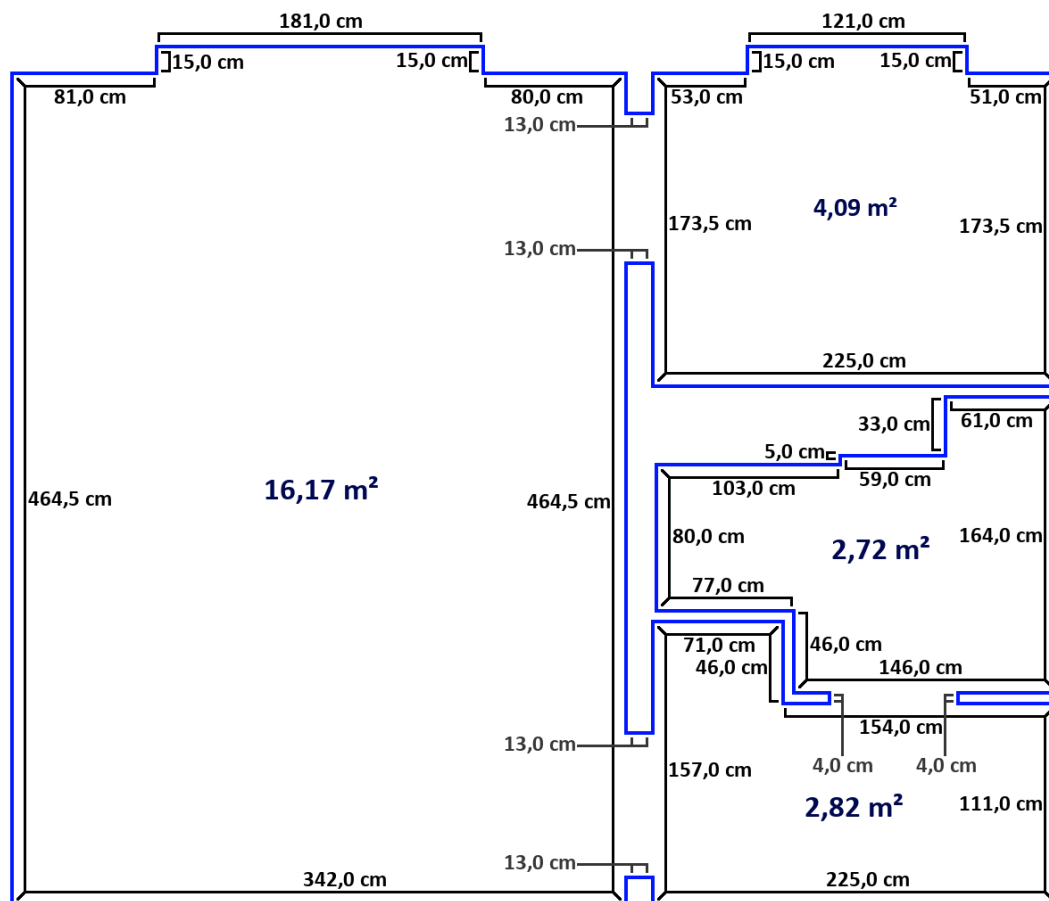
Durch Handvermessung erstellter Grundrissplan mit Bemaßung.
